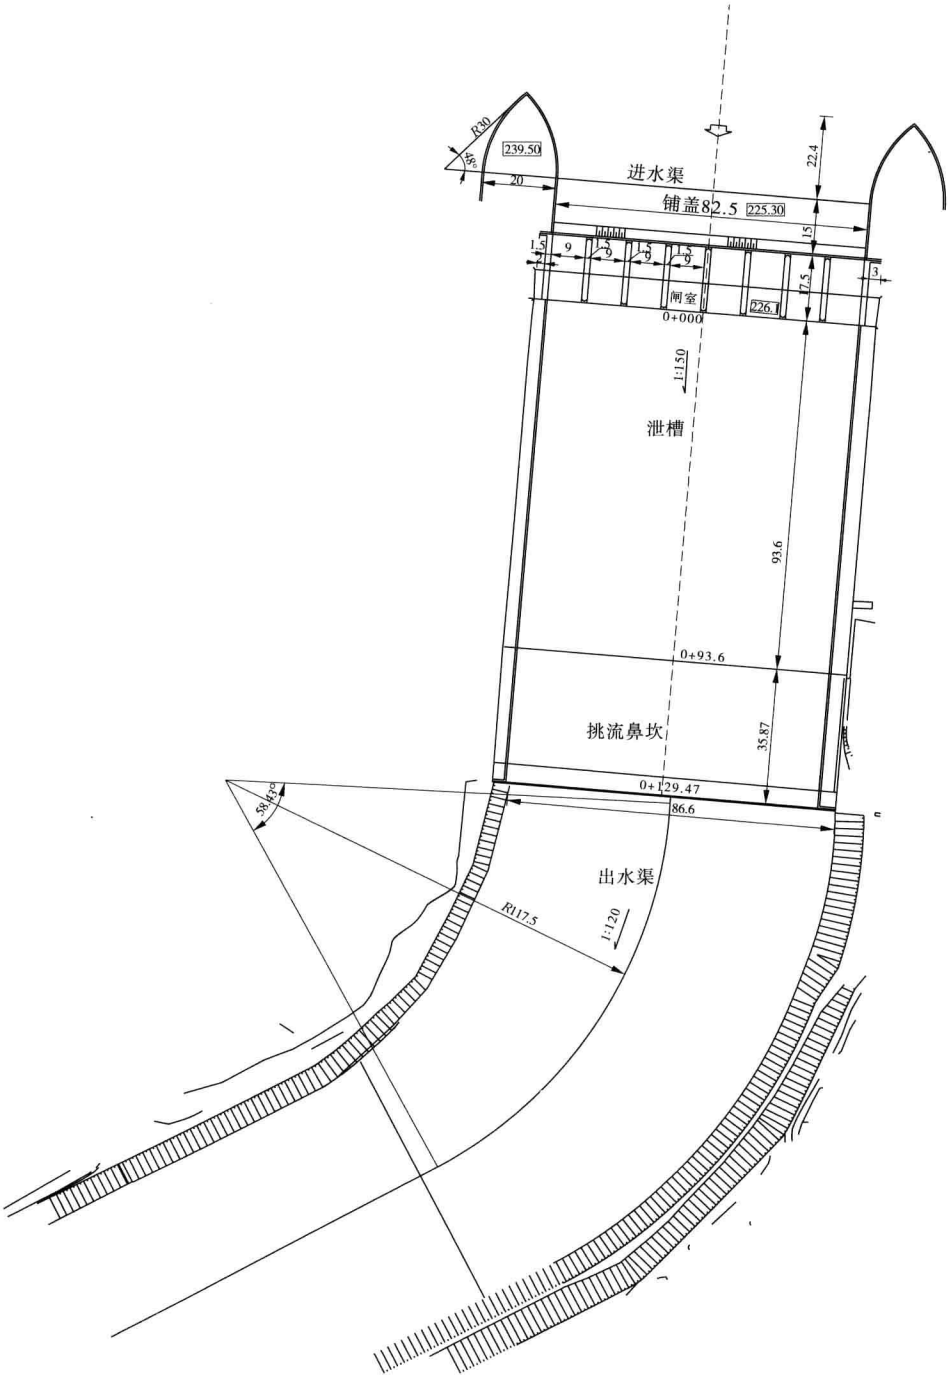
雪野水库溢洪道平面布置图 (单位:m)
